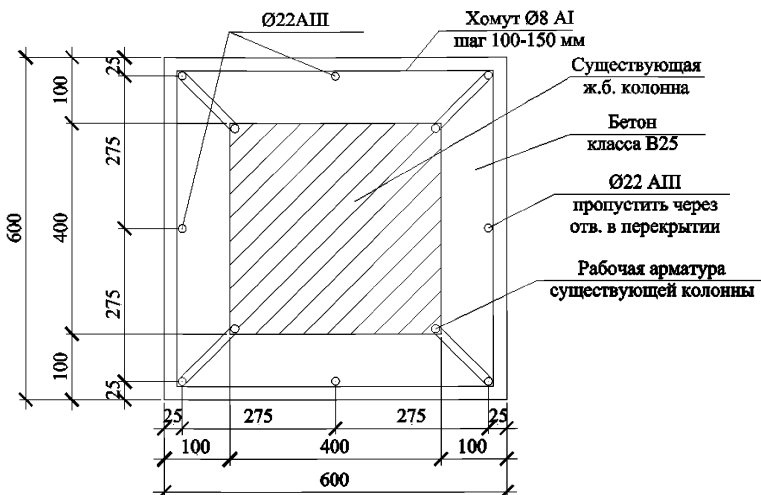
Усиление колонны железобетонного каркаса
